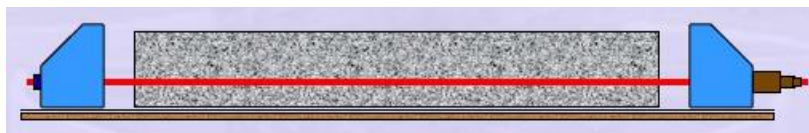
Betonagem do elemento (Sengupta & Menon, n.d.).
